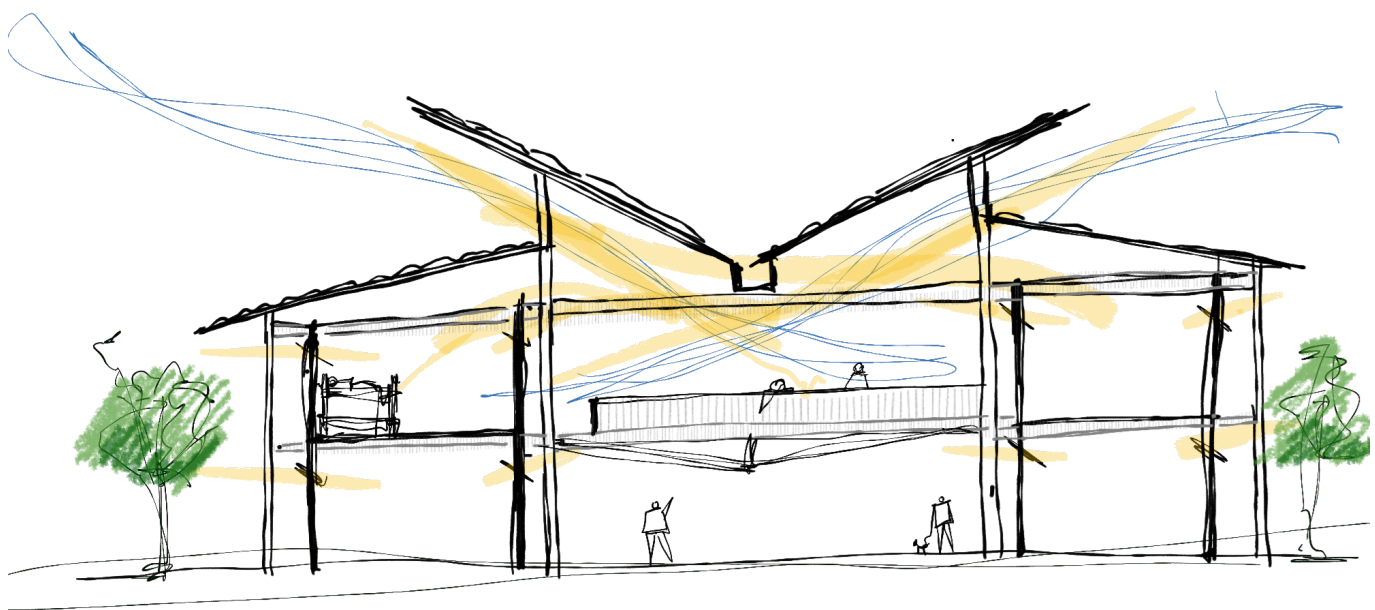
Croqui de estudo de iluminação e ventilação naturais / Fonte: Autoria do grupo.
